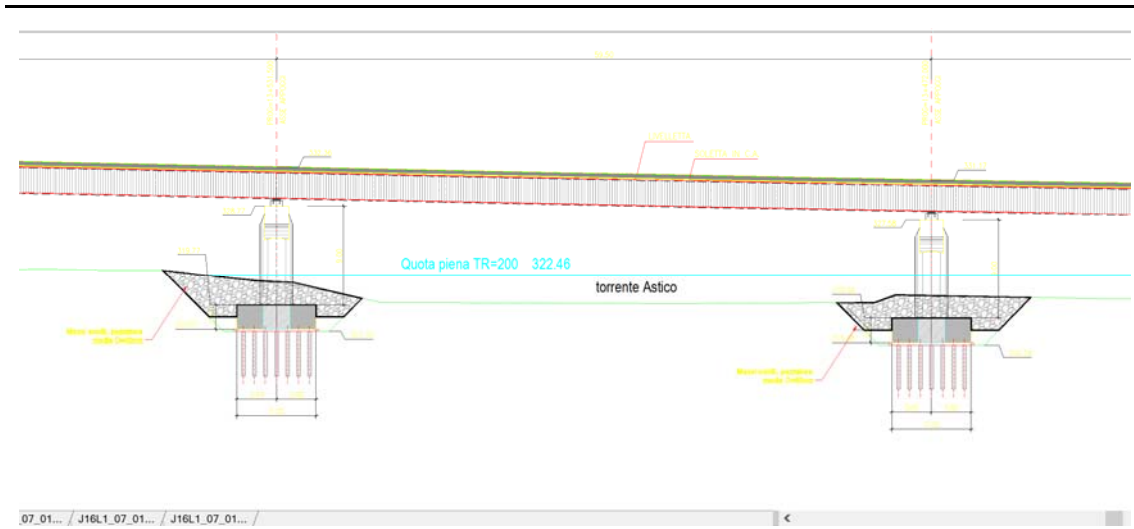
Viadotto Settecà protezione pile 7 e 6 viadotto Nord
